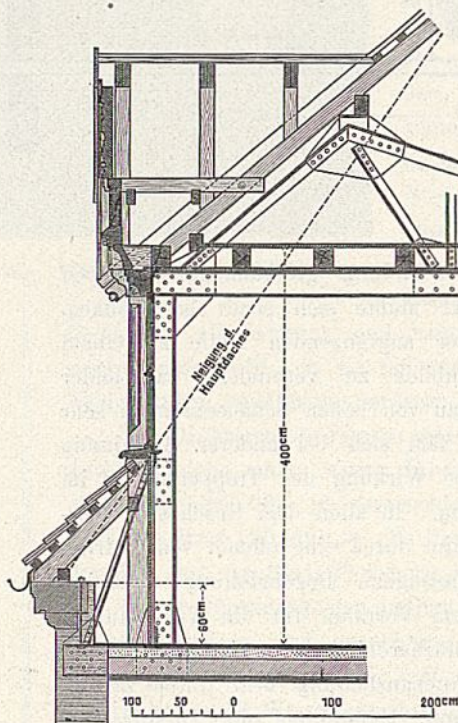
Schnitt durch den hölzernen Dachaufbau.
